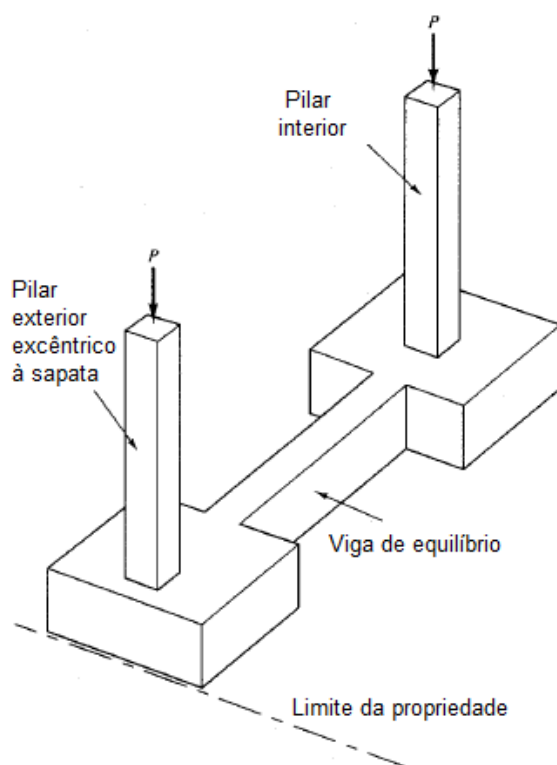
Esquema de conexão entre sapatas isoladas: uma com pilar excêntrico e outra com pilar centrado [adaptado 21]
